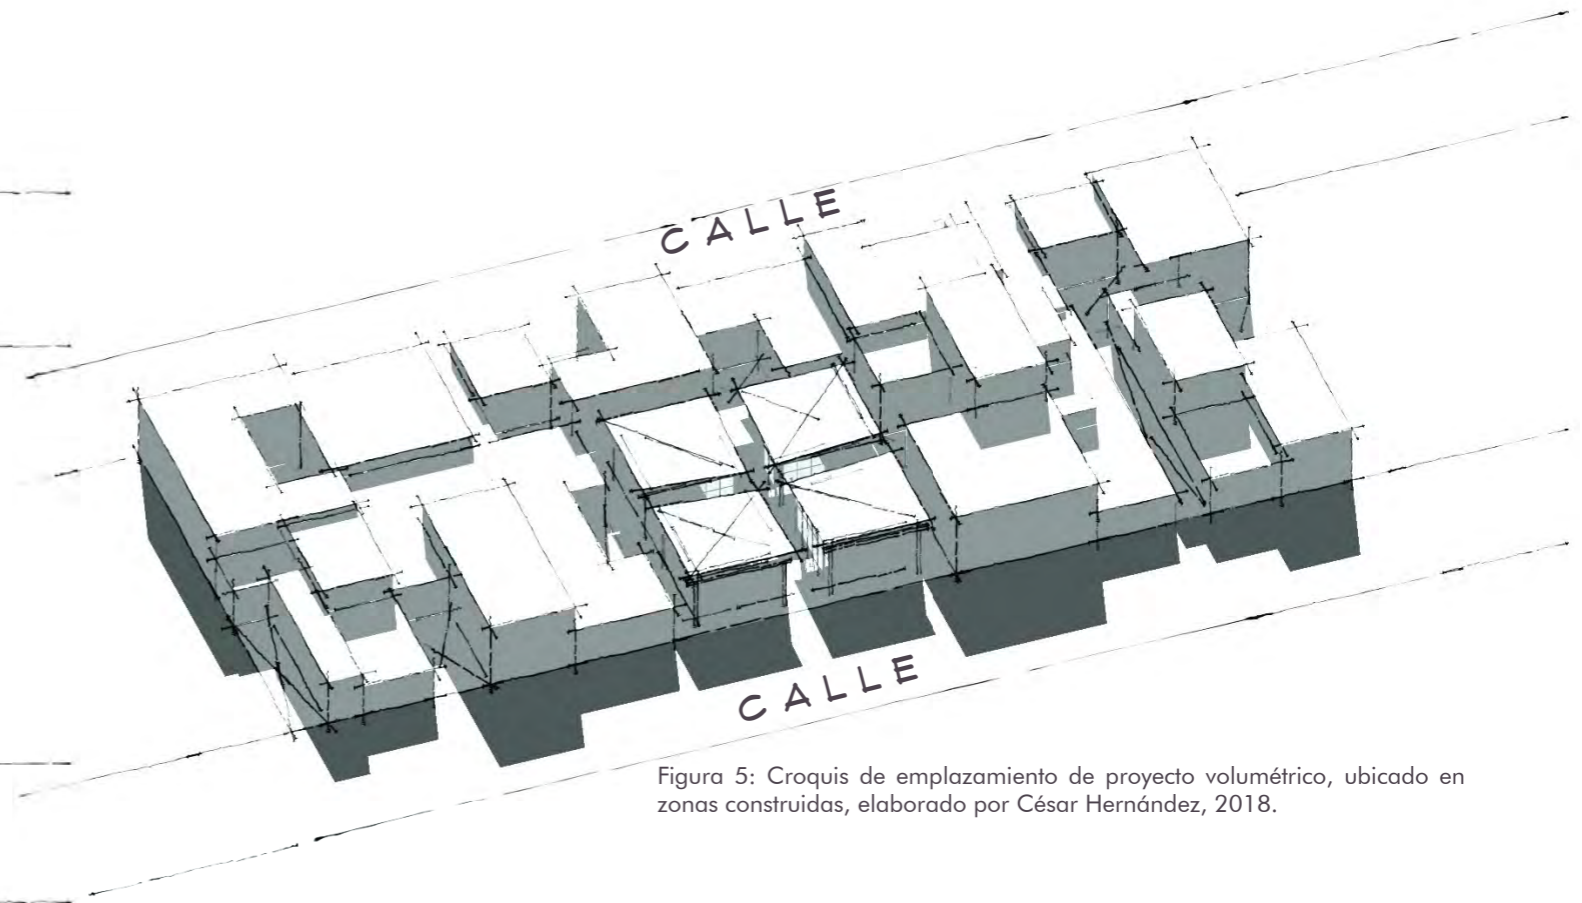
Croquis de emplazamiento de proyecto volumétrico, ubicado en zonas construidas, elaborado por César Hernández, 2018.
